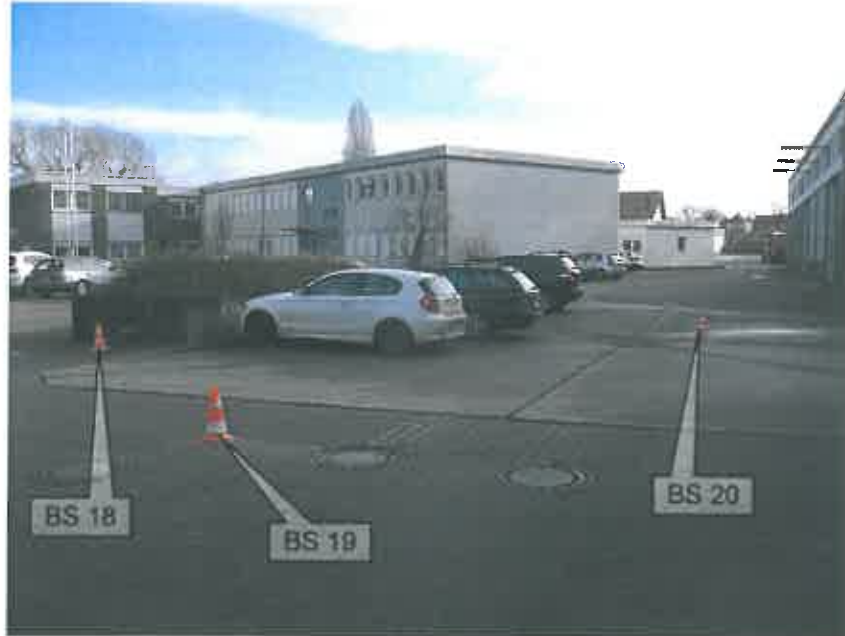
Blickrichtung ~ ONO; Bereiche der BS 18, BS 19 und BS 20 (Markierungen)
